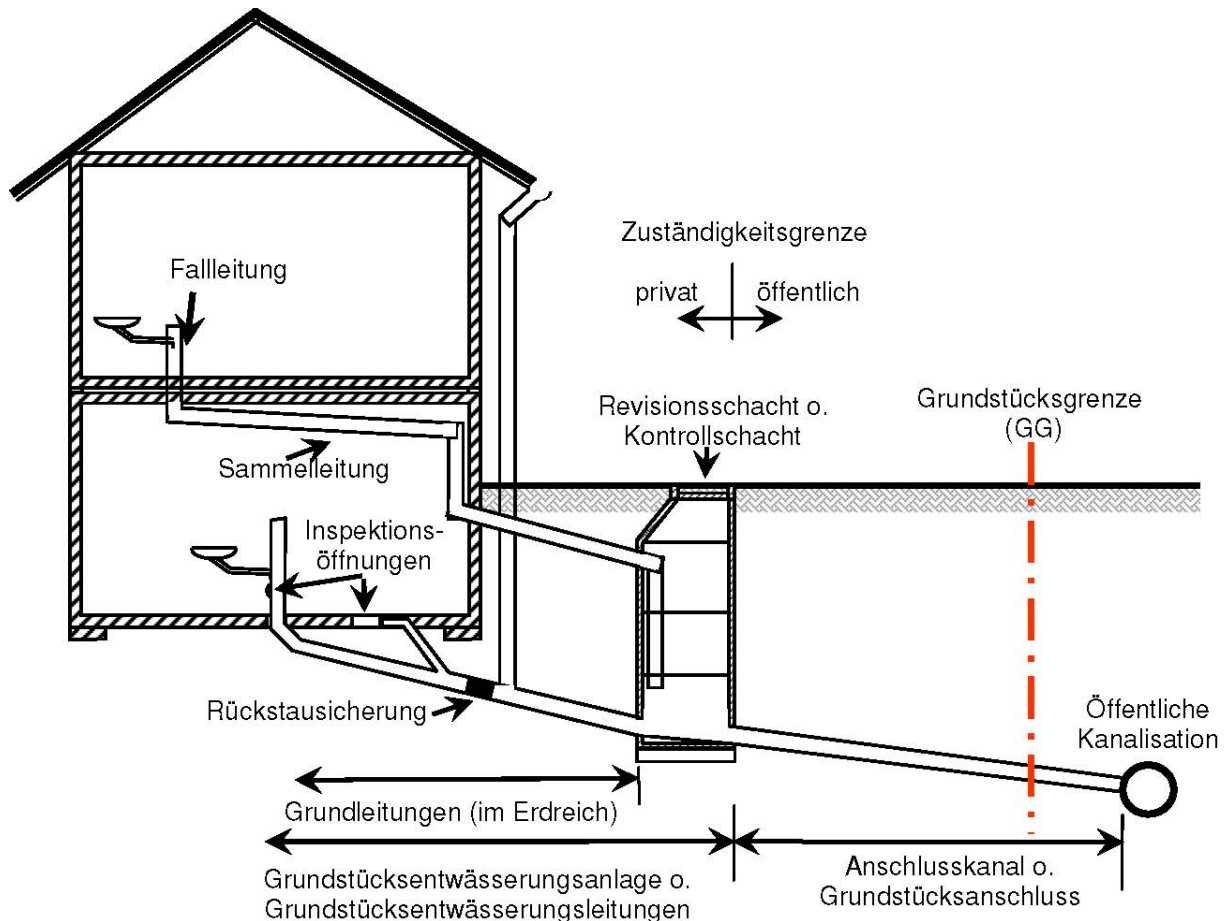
Aufbau einer Grundstücksentwässerungsanlage (Cvaci, 2009)
